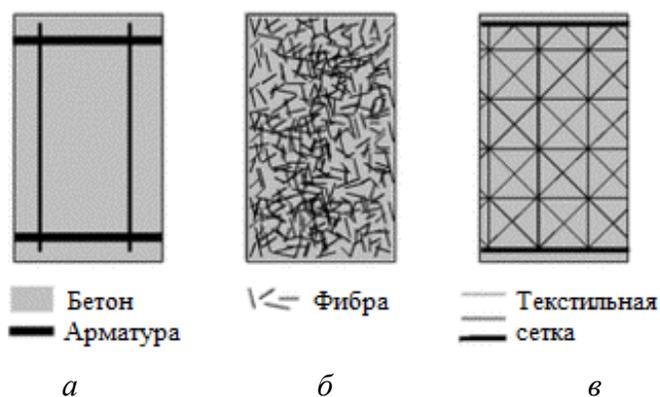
Виды армирования бетонов: железобетон (а); фибробетон (б); текстиль-бетон (в)
